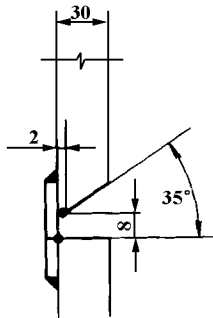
钢管柱 - 柱安装拼焊坡口形式及尺寸
